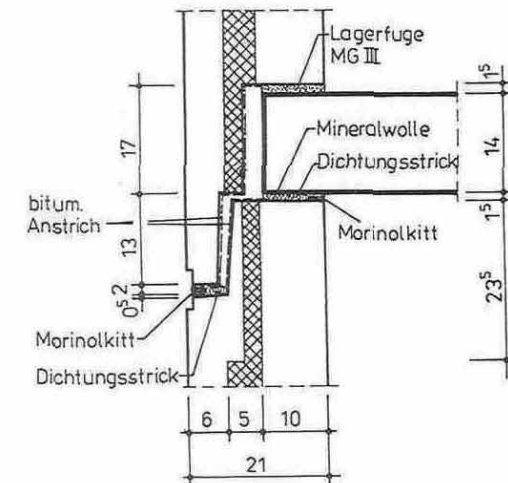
WHH GT Fugendetail - geschlossene Horizontalfuge
